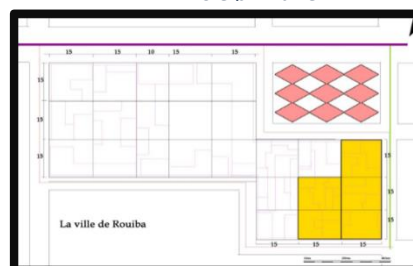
plan des parcelles donnant sur la voie secondaire
